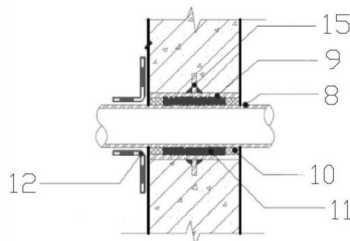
穿墙管与混凝土侧墙之间的连接结构示意图
